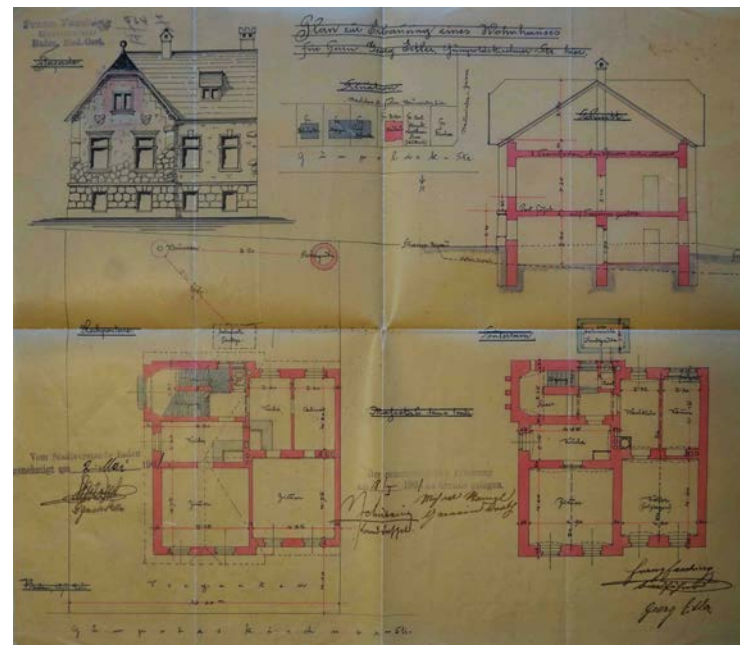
Einreichplan Germergasse 38, 2.5.1901.
